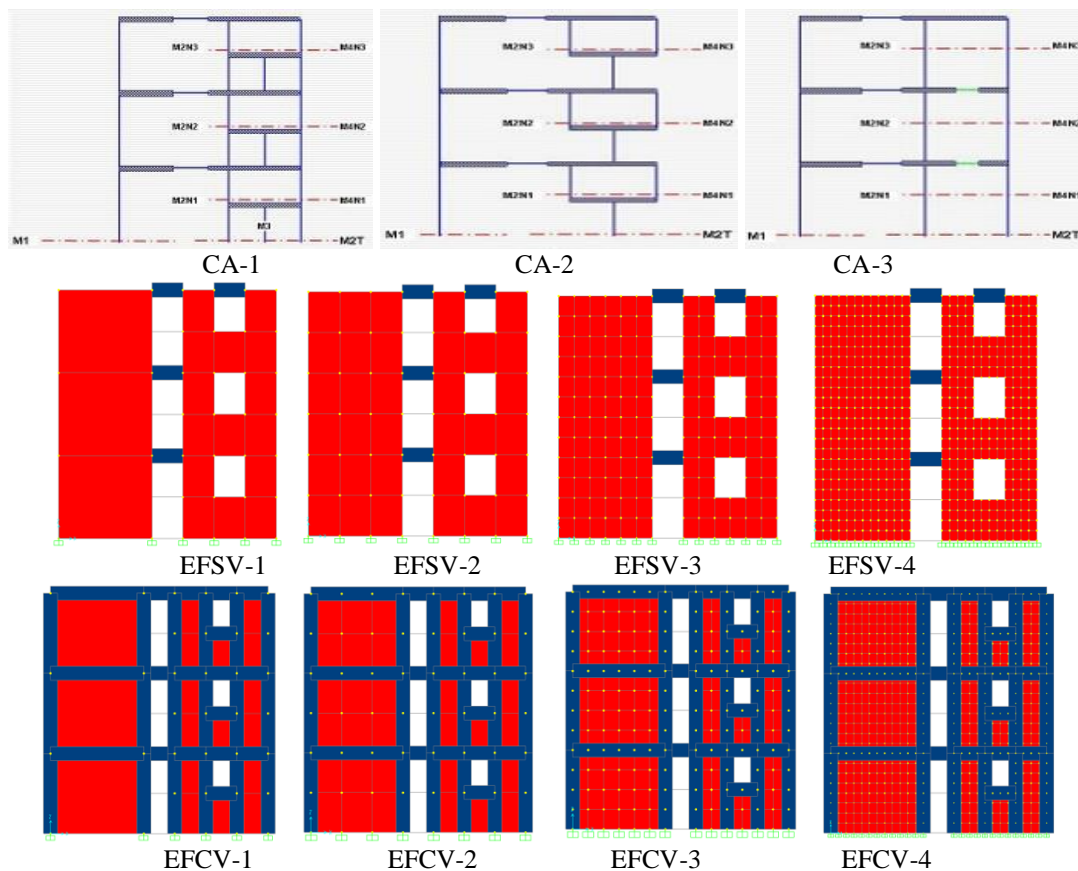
Alternativas de modelado de muros: Columna ancha, MEF con elementos tipo Shell y MEF con elementos tipo Membrane, respectivamente (modificado de Pérez-Gavilán, 2007).
